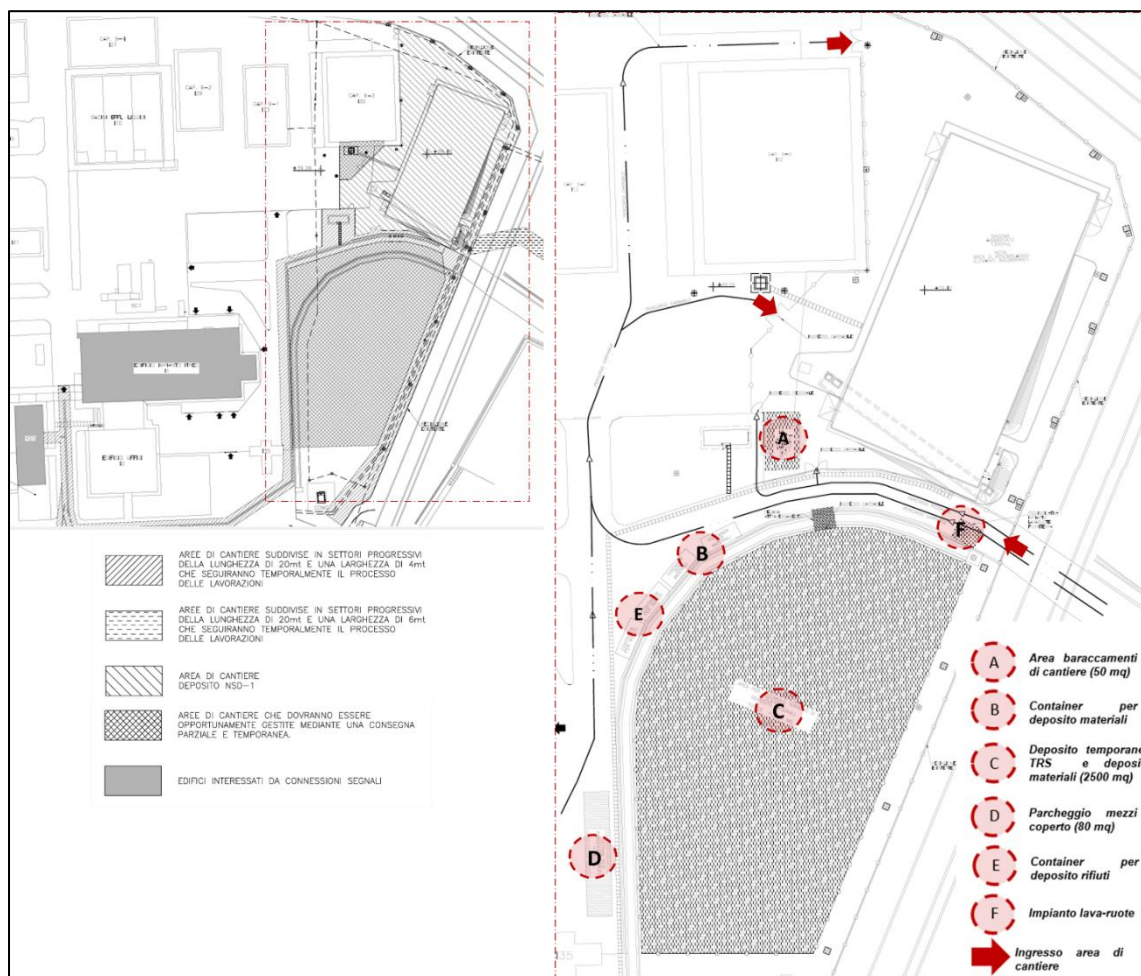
Lay-out di cantiere (IT ND 00141)
